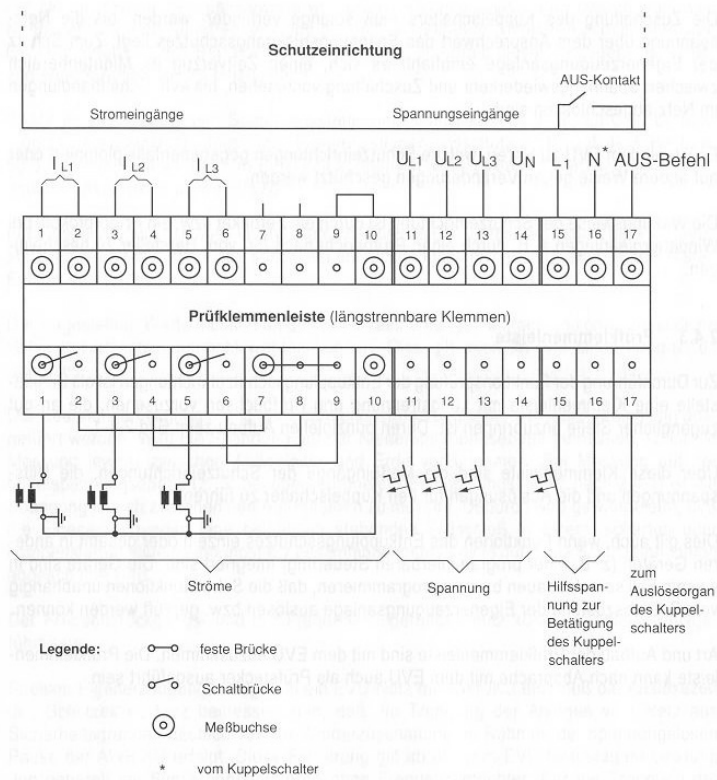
Prinzipieller Aufbau der Prüfklemmenleiste
